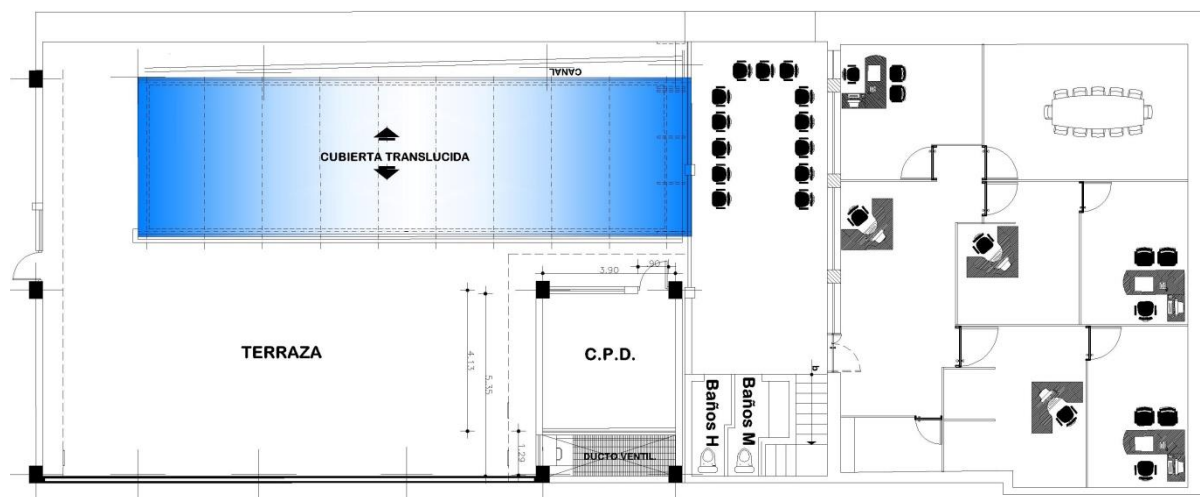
Plano arquitectónico actual de la ubicación del CPD en la terraza.
